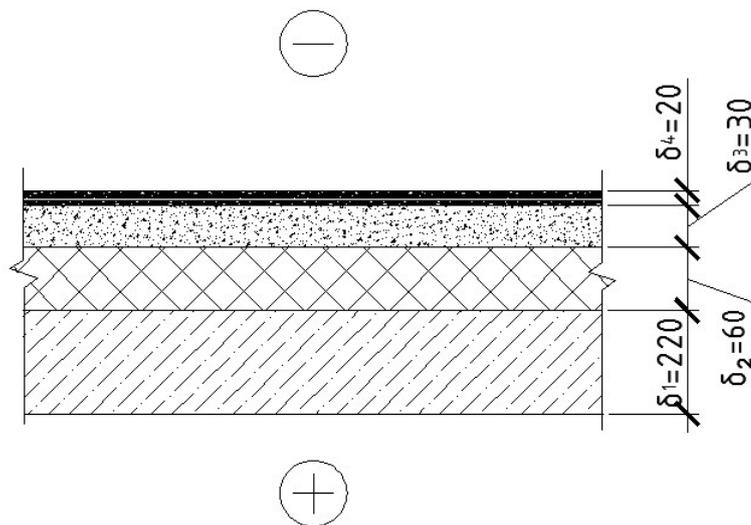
Розрахункова схема перекриття над неопалюваним підвалом
